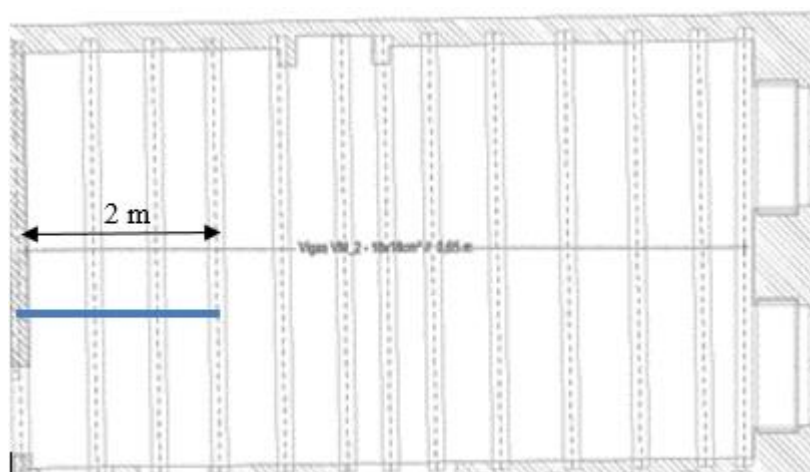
Planta estrutural do pavimento PVRR_8
